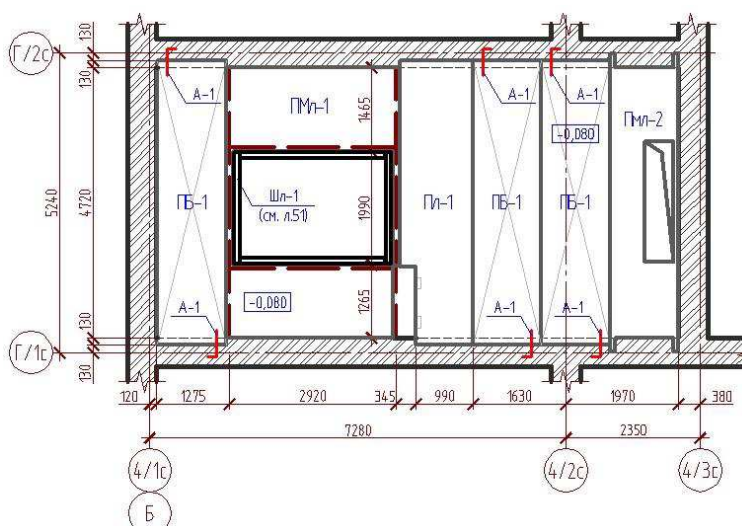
Рассматриваемый участок плиты перекрытия лестничной клетки
